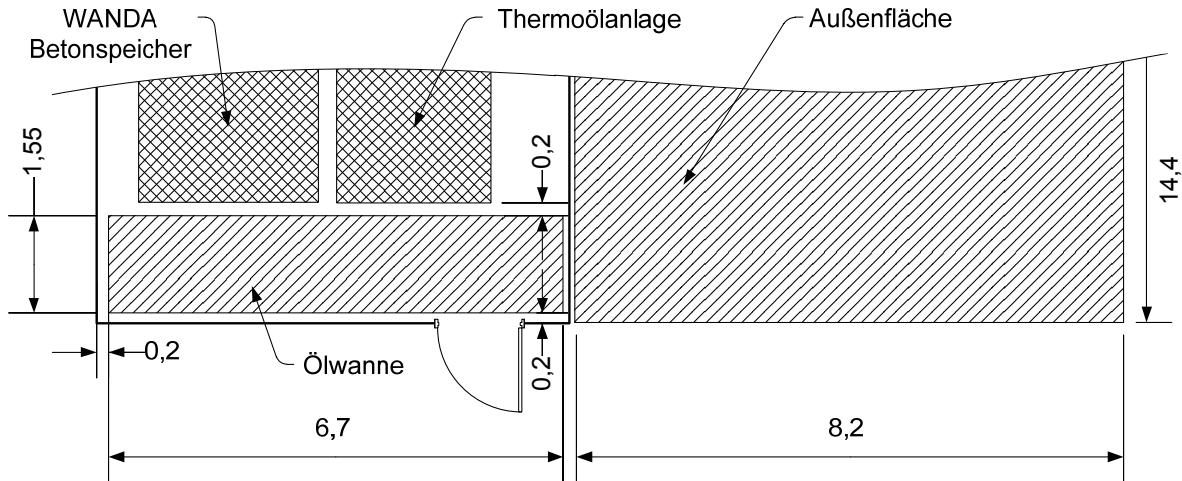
Grundriss der zur Verfügung stehenden Hütte und des anschließenden Geländes vor dem Aufbau der Pilotanlage, Längenangaben in Meter
